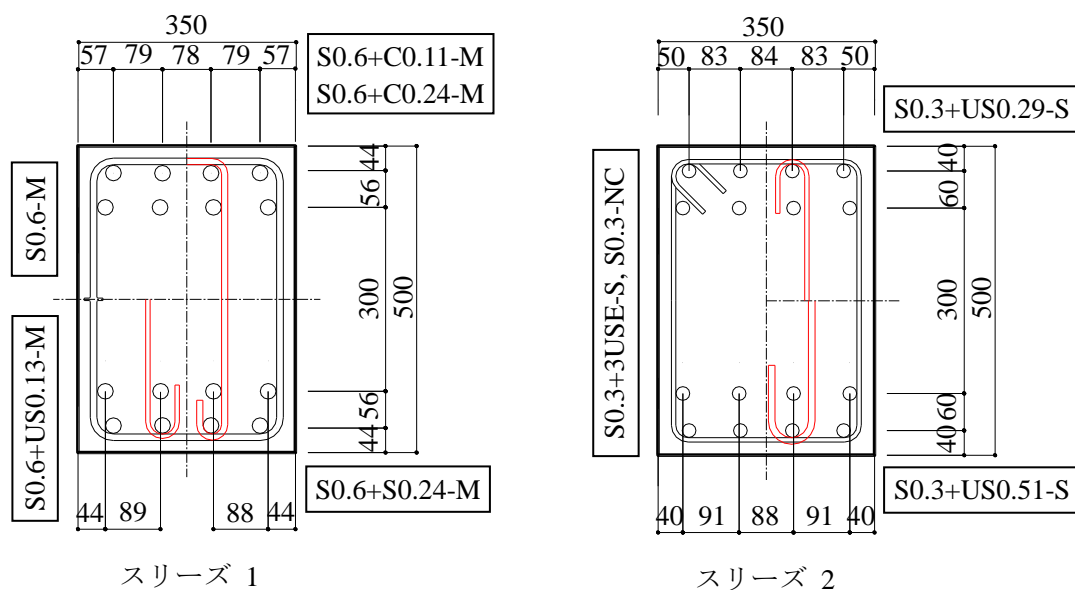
付着割裂補強筋の配筋詳細
